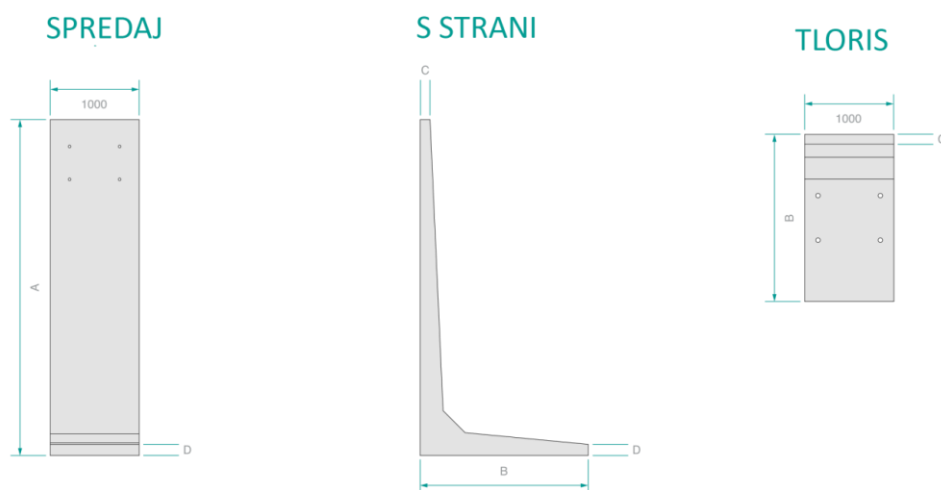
Sidranje prefabriciranega betonskega opornega zidu v tla
